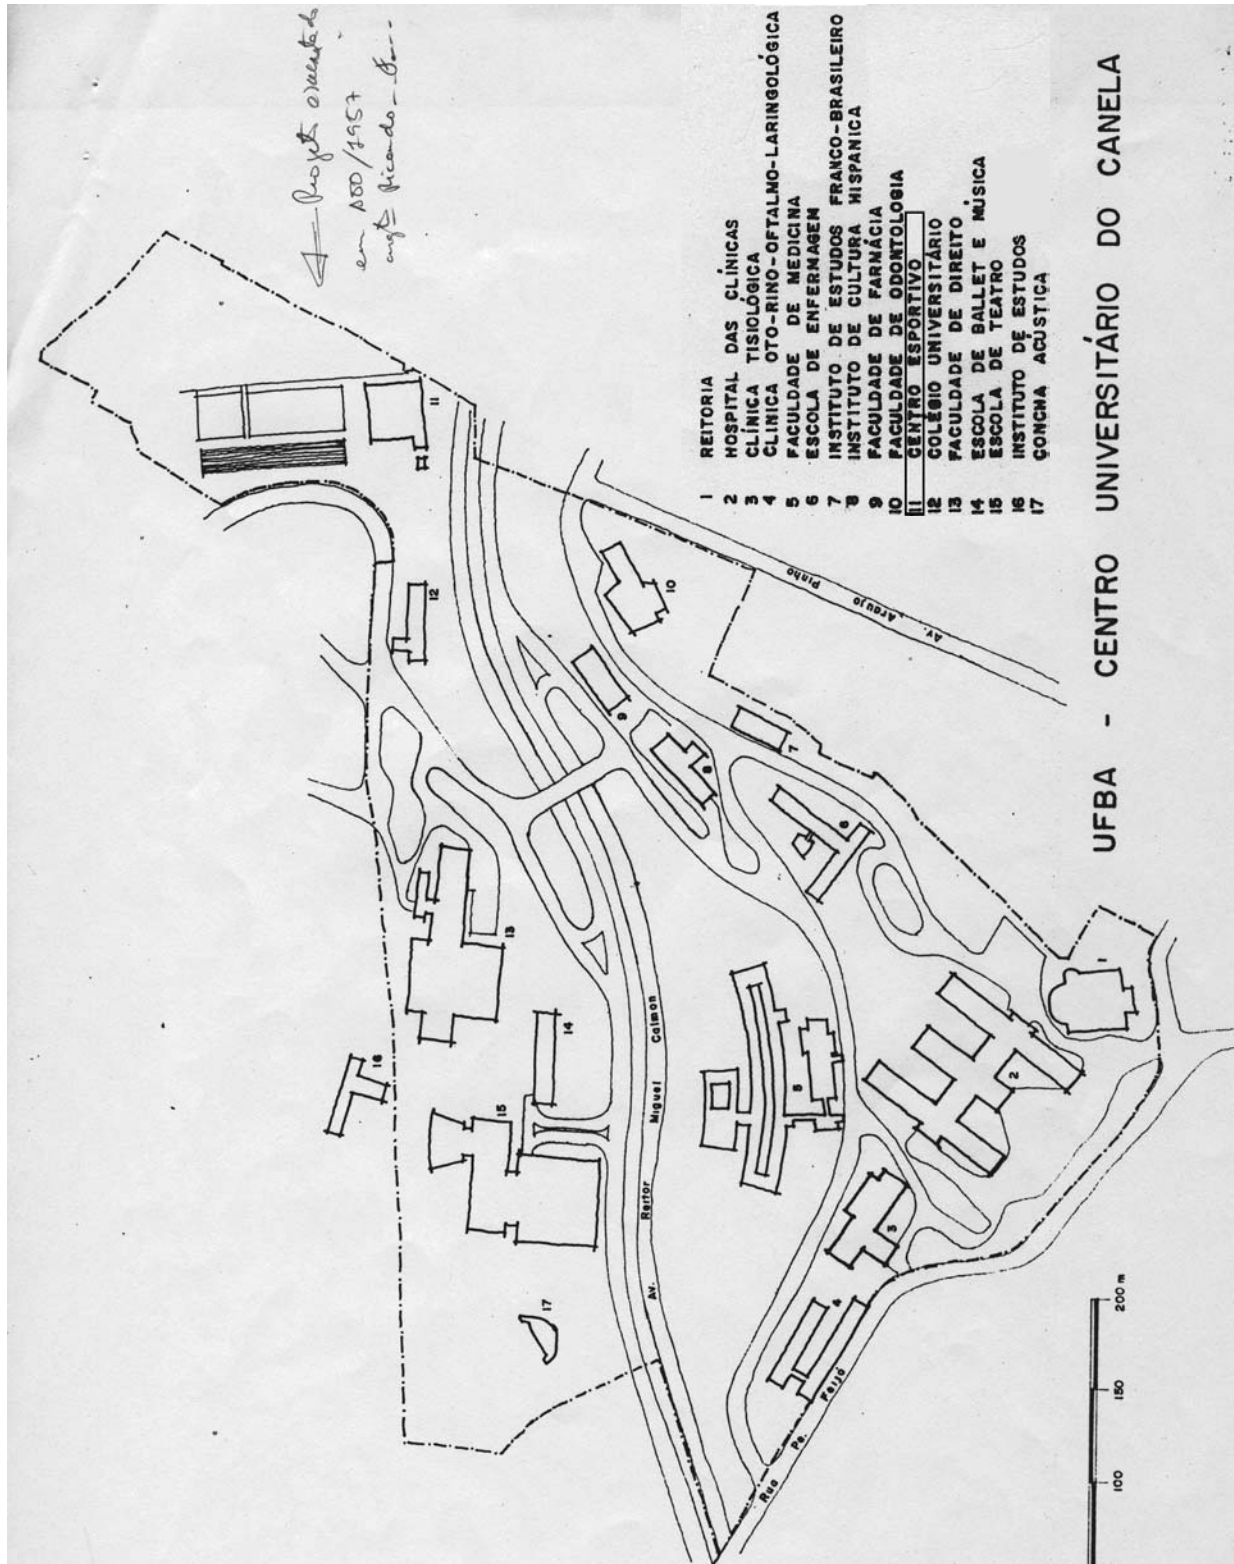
Planta Arquitetônica da UFBA 1957 II
